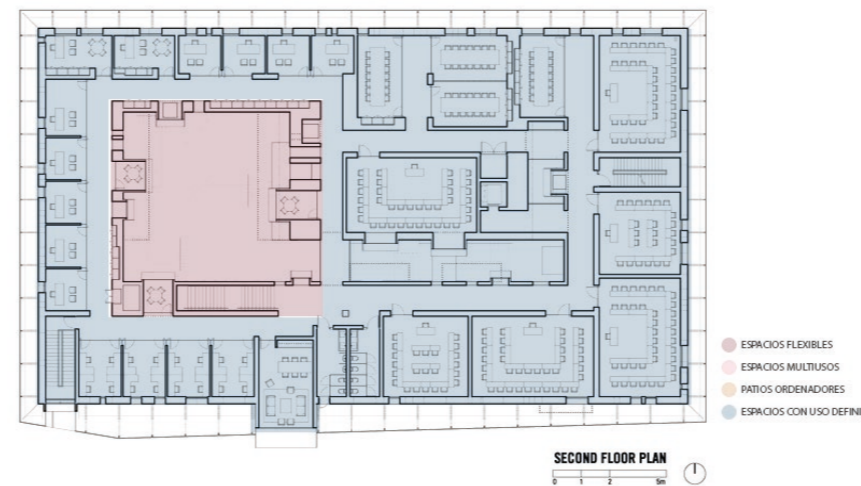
Planta tercer piso Adaptado de Plataforma de Arquitectura, 2015
